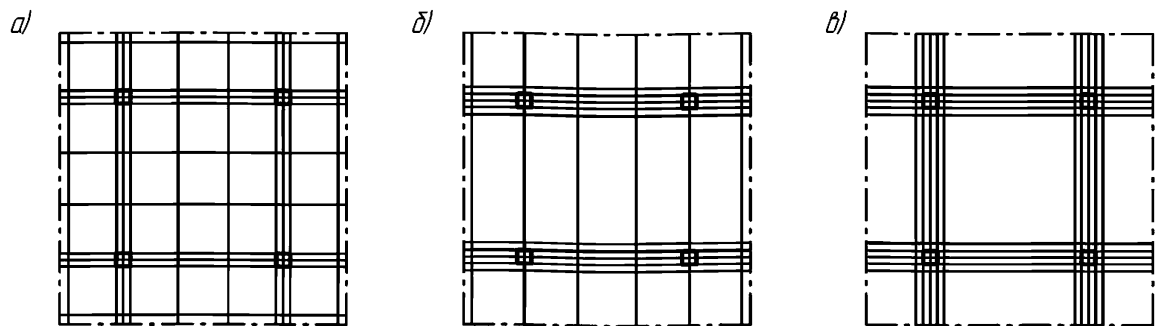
Схемы расположения арматурных элементов по полю перекрытий (а – с расположением по длине и ширине со сгущением у колонн, б – с расположением по длине равномерно и сосредоточенно по ширине у колонн, в – с сосредоточенным расположением по длине и ширине у колонн – по типу скрытых балок)
